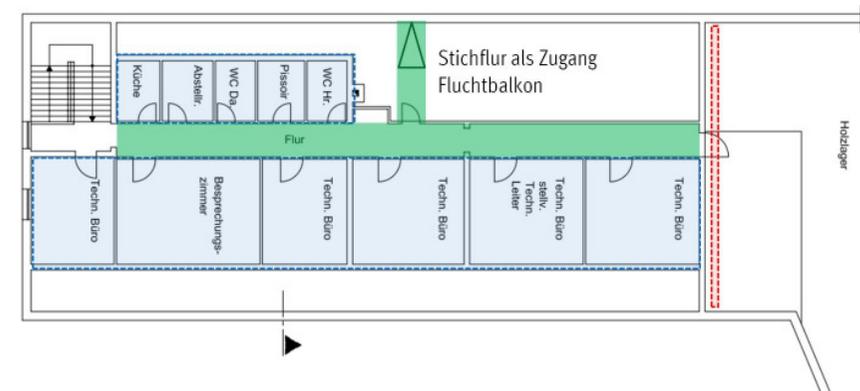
Schematische Darstellung der wiederherzustellenden Raumaufteilung inkl. Stichflur zum Dachausstieg und Fluchtbalkon als 2. Baulichen
